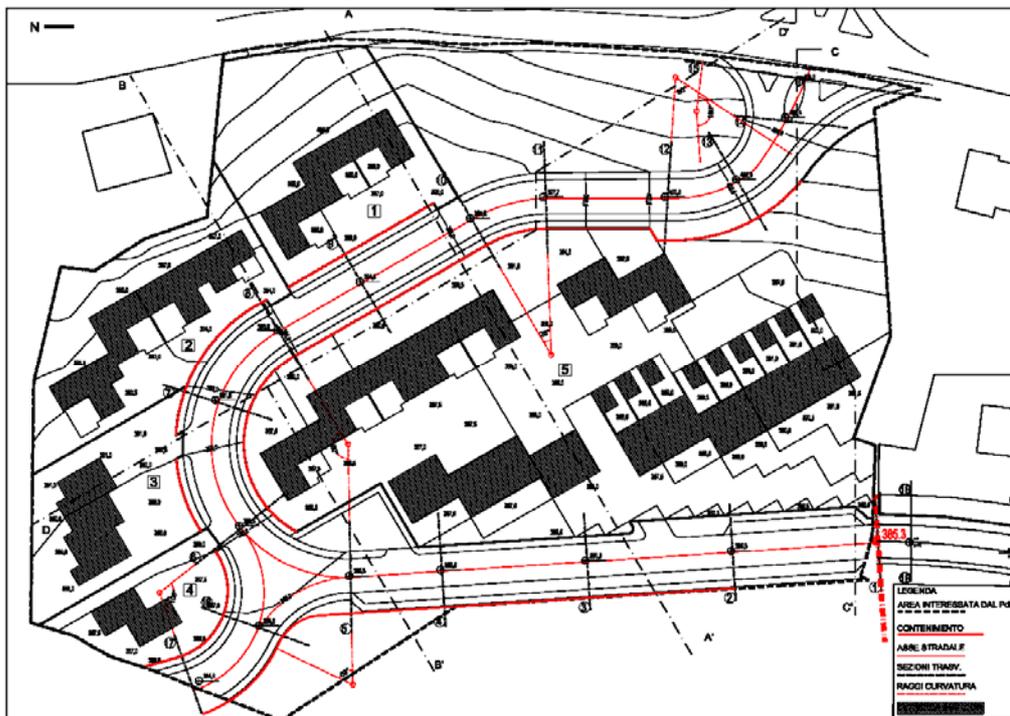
Piano quotato modificato e progetto di piano ottobre 2008
